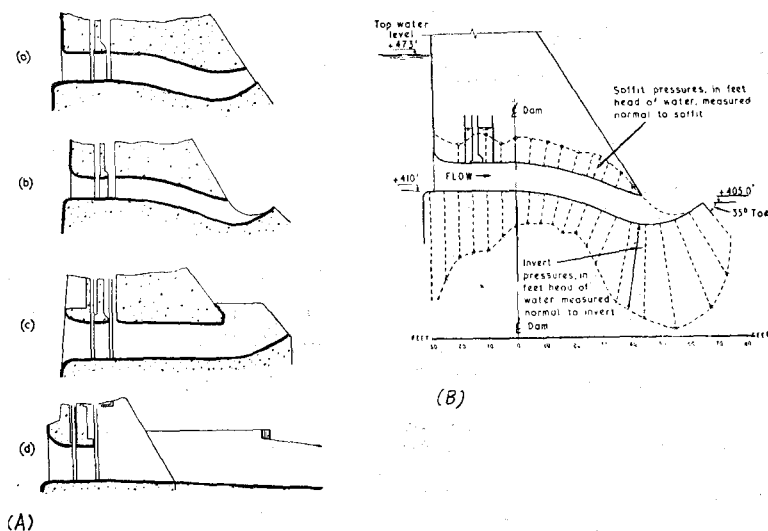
英国における outlet works (draw-off culvert) の例¹¹⁾
